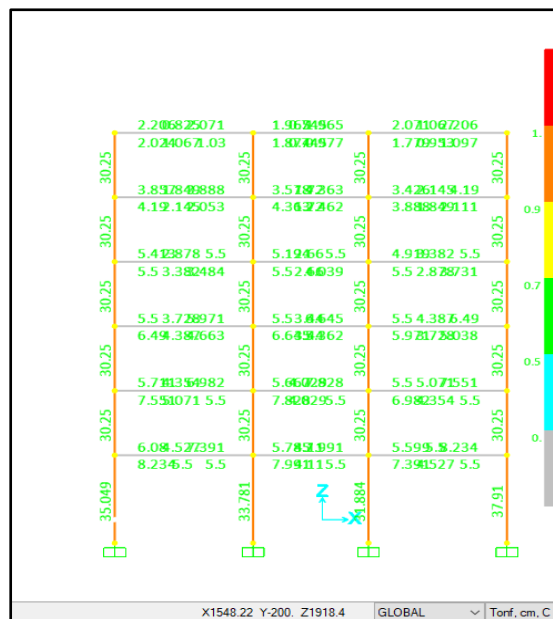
Área de acero en cm<sup>2</sup> para columna y viga
